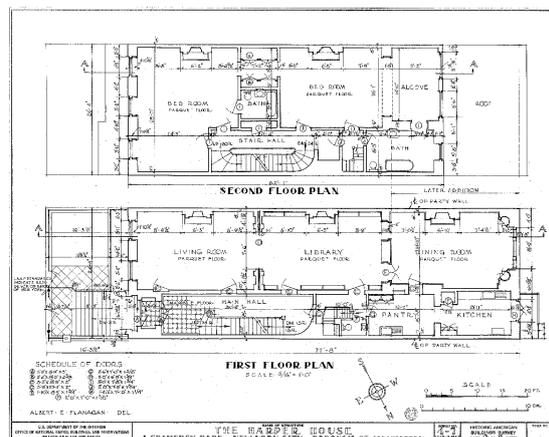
ロウハウス平面図の例 THE HAPPER HOUSE
